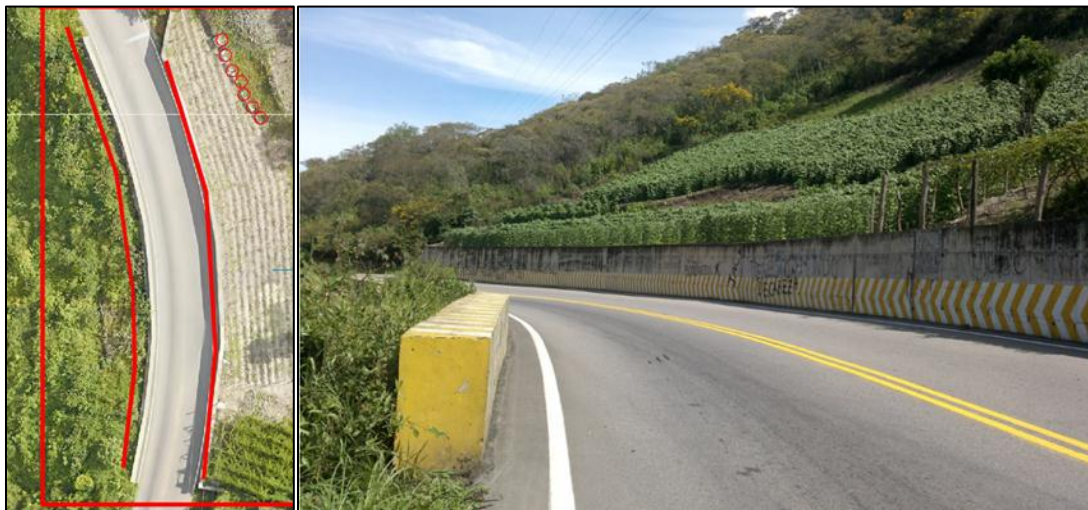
Vista en planta del sitio crítico 8. (Fuente: Elaboración propia).
